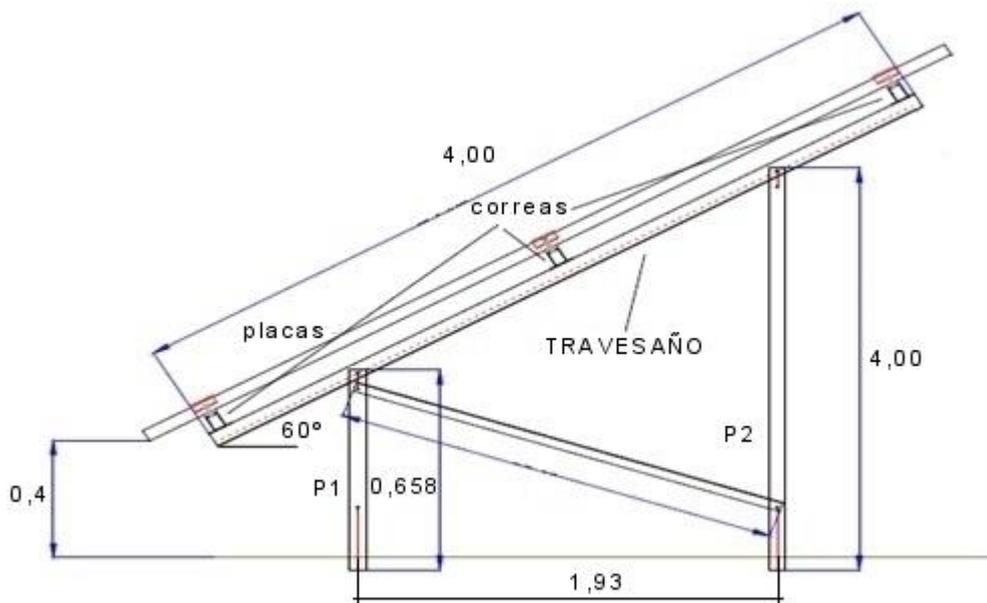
dimensionamiento de la estructura de las placas 60°
